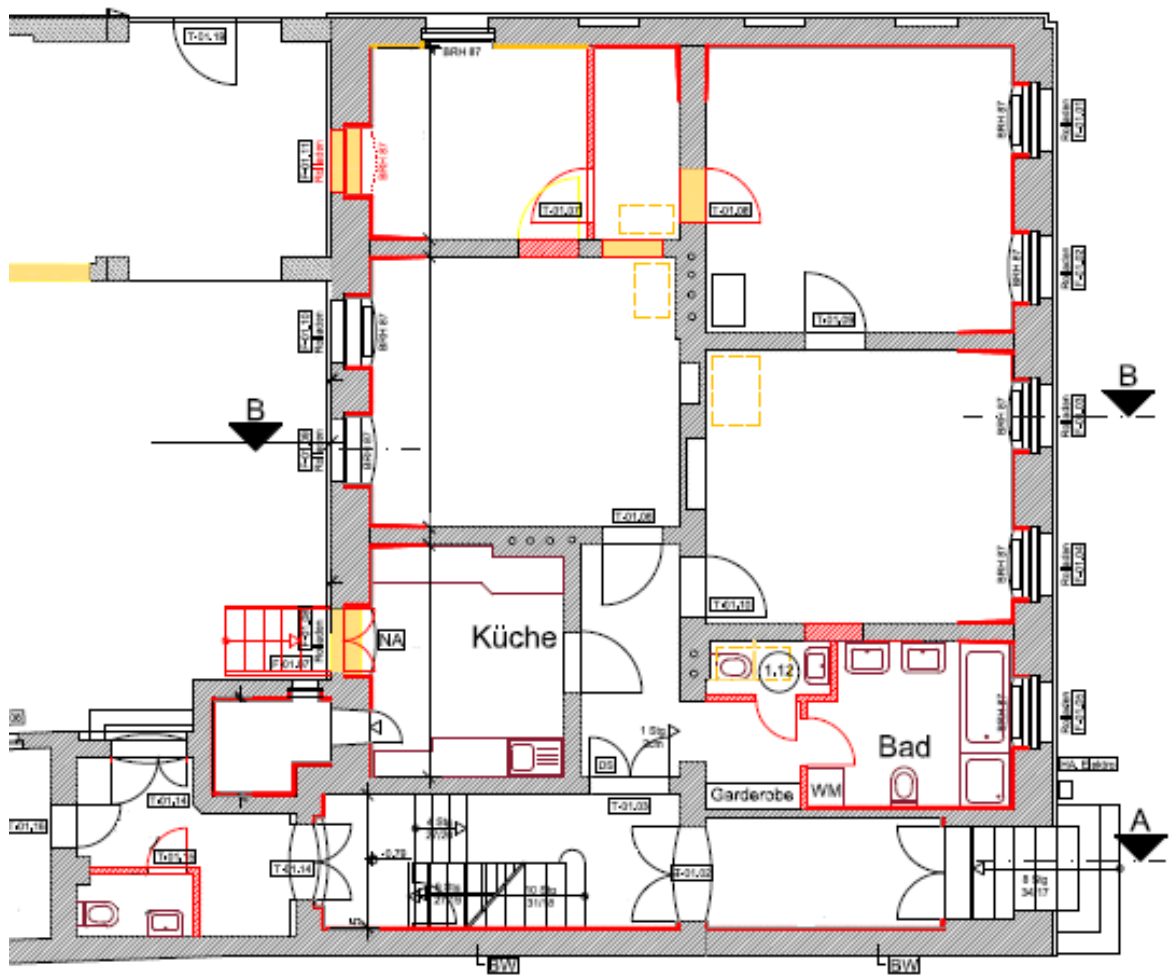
Grundriss Sanierung Erdgeschoss<sup>170</sup>
